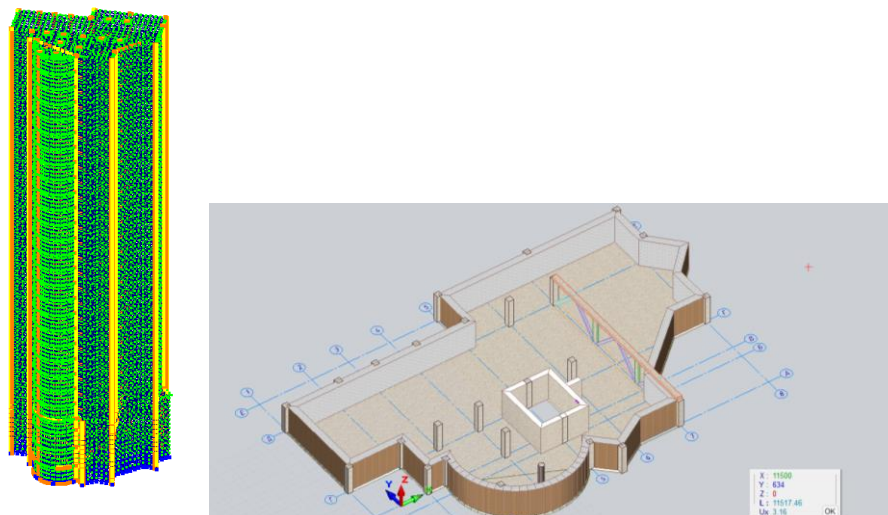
Расчетная схема высотного здания с переходным этажом и схема переходного этажа (3D вид)
